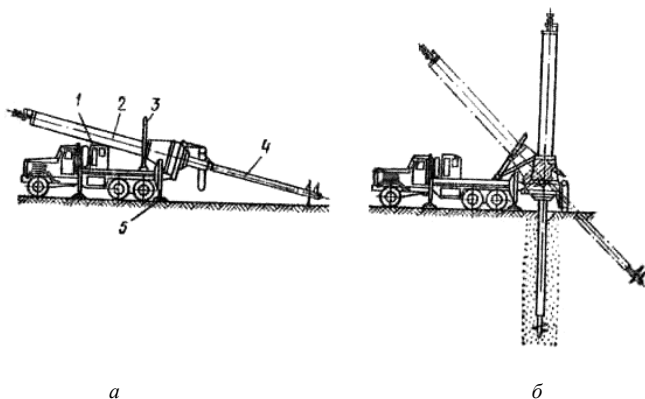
Схема самоходного свезавинчивающего агрегата:
